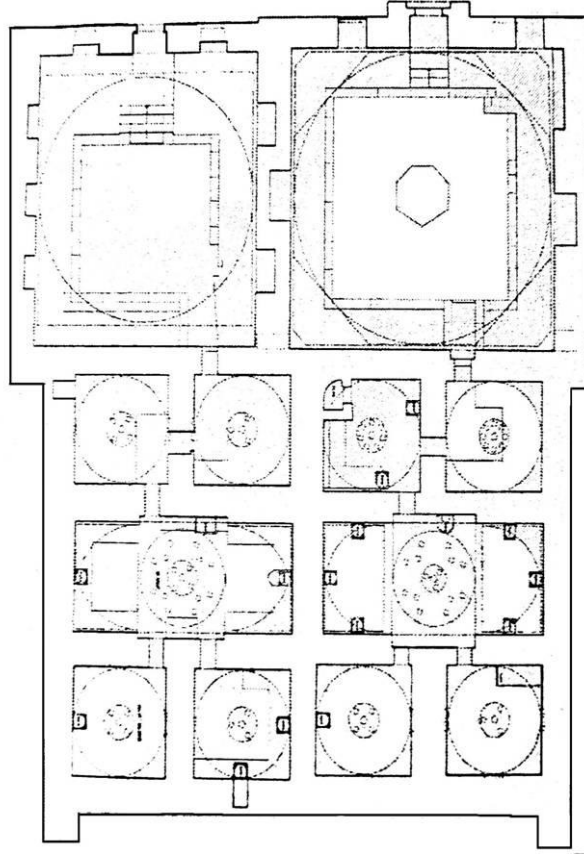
Edirnekapı Mihrimah Hamamı (İstanbul) plan şeması
